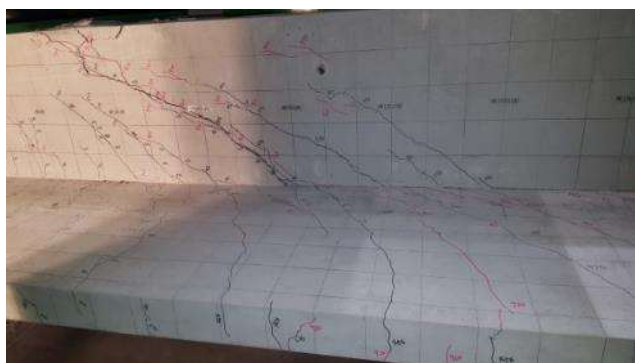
No.3 試験体の最大荷重時ひび割れ性状
